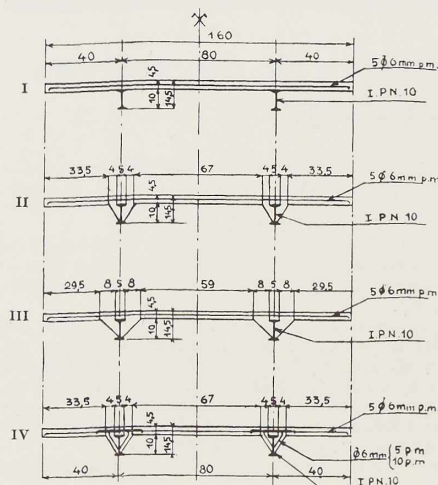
Les solives des hourdis I à IV sont des poutrelles P.N. 10. La dalle repose sur les poutrelles.
